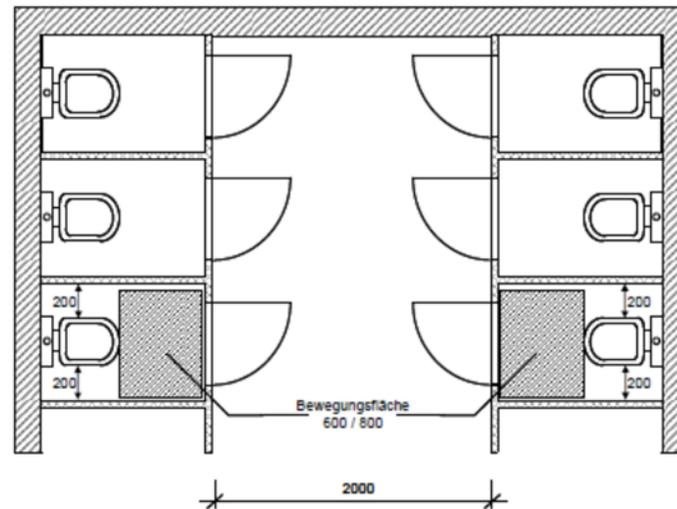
Zweibündige Toilettenanlage, Türanschlag nach außen (Maße in mm)
